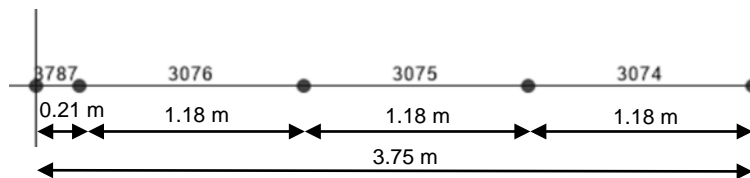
Identificação da Viga V4.5 da Travessa do Pórtico 5
